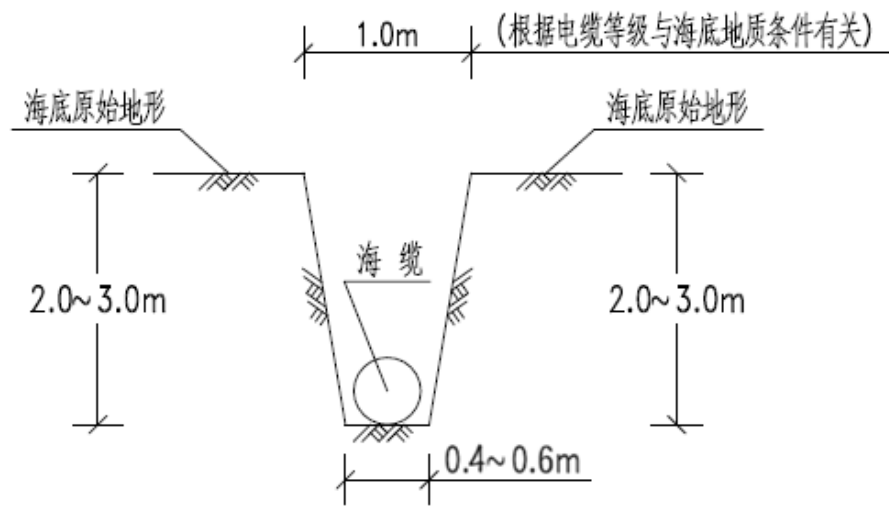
近海海域（水深>3m）开挖施工断面示意图
